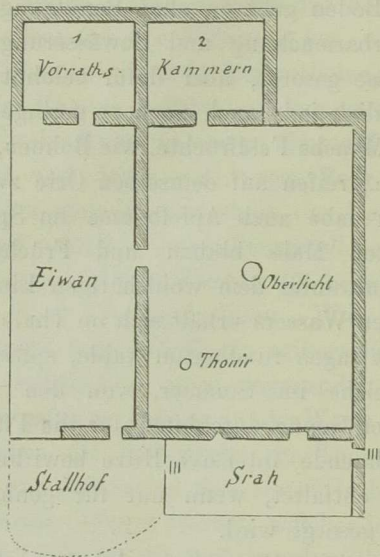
Grundriss eines Hauses in dem Dorfe Meghri.
